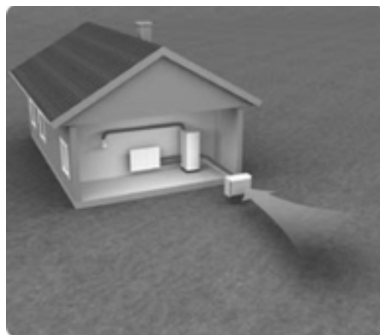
Воздушный тепловой насос для отопления жилого дома.
